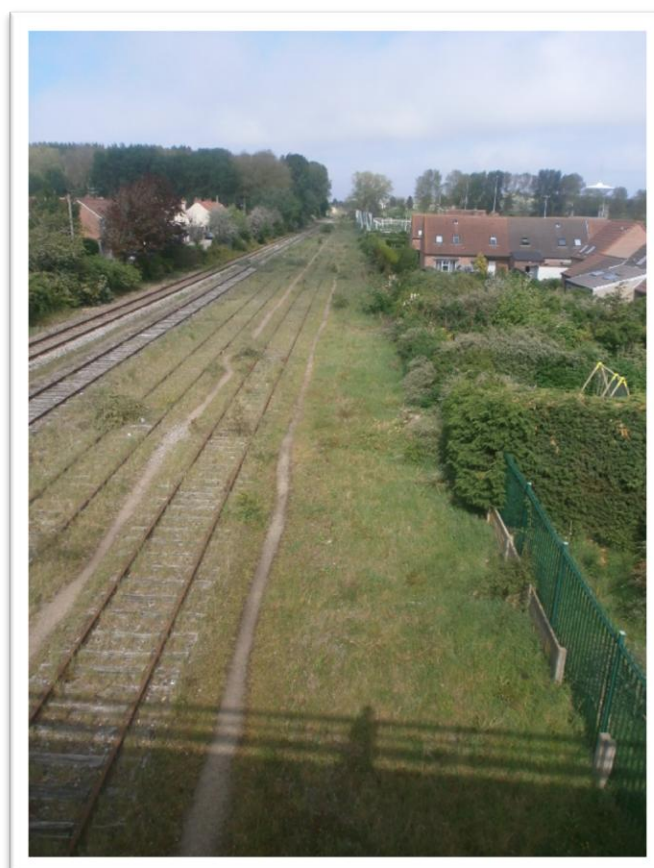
depuis la passerelle vers l'ouest
